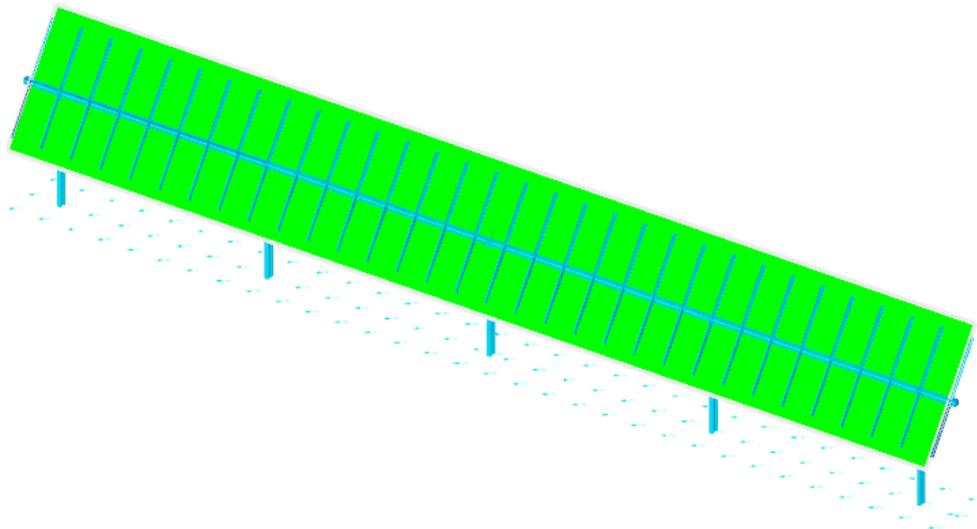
Vista assonometrica modello strutturale con posizione della “vela” inclinata di 60°
